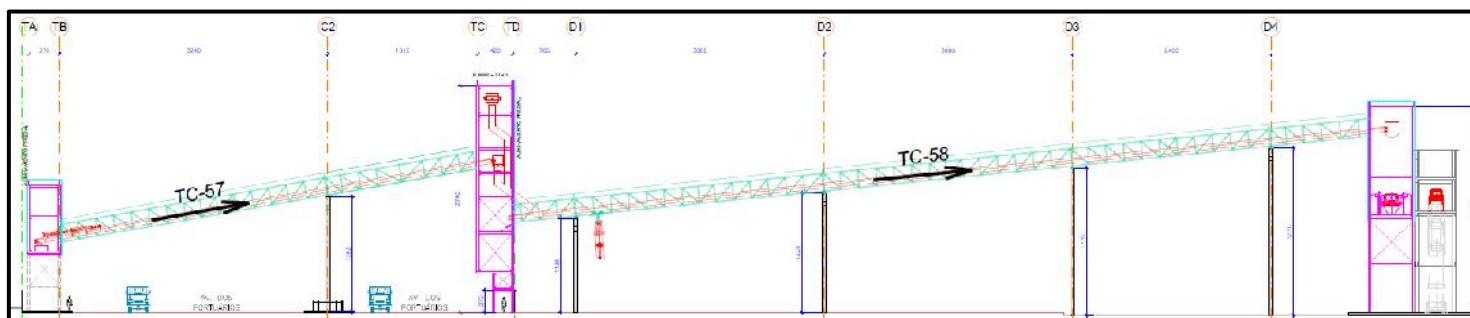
Corte longitudinal da TC-57 e TC-58.
